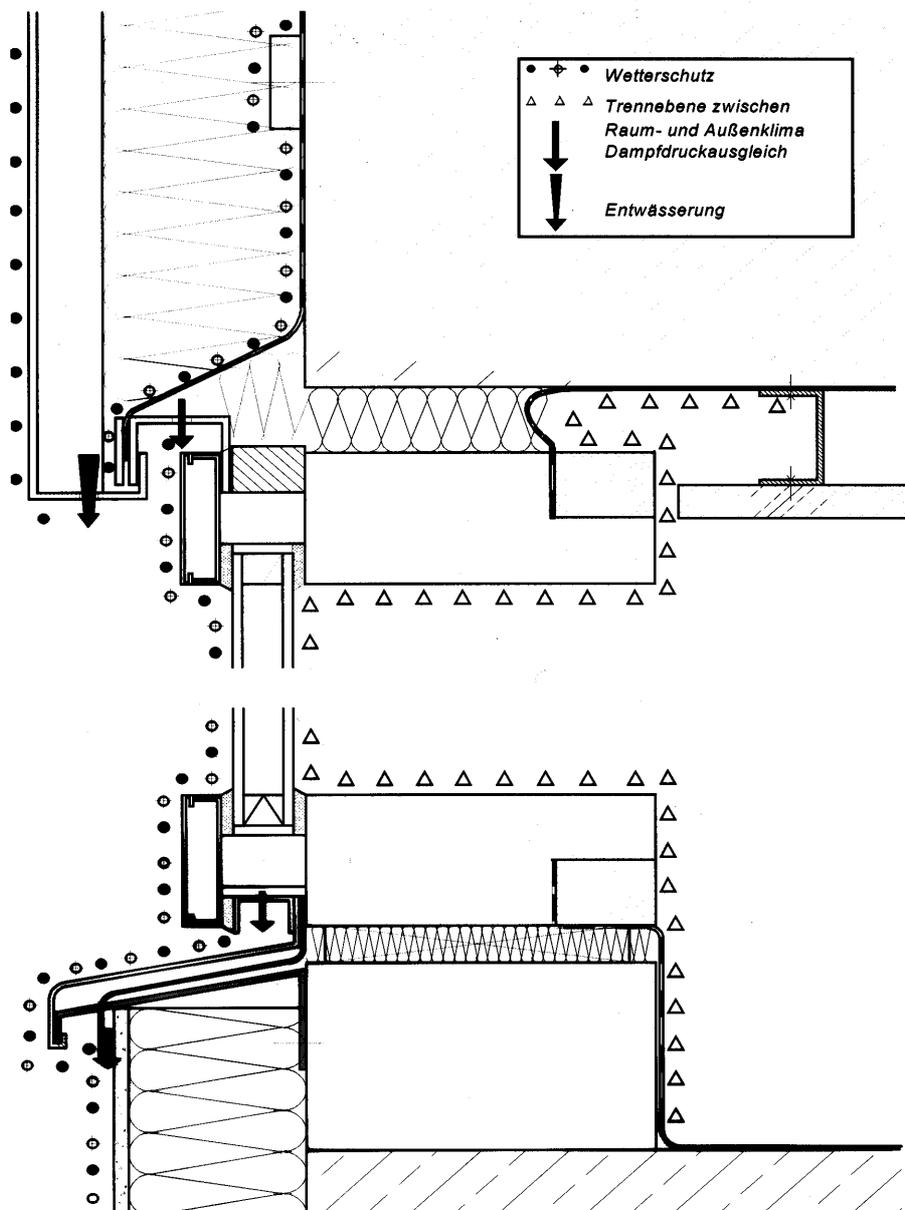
Schema des Fassadenanschlusses mit konstruktiver Öffnung zum Dampfdruckausgleich auf der Außenseite <sup>[3]</sup>
